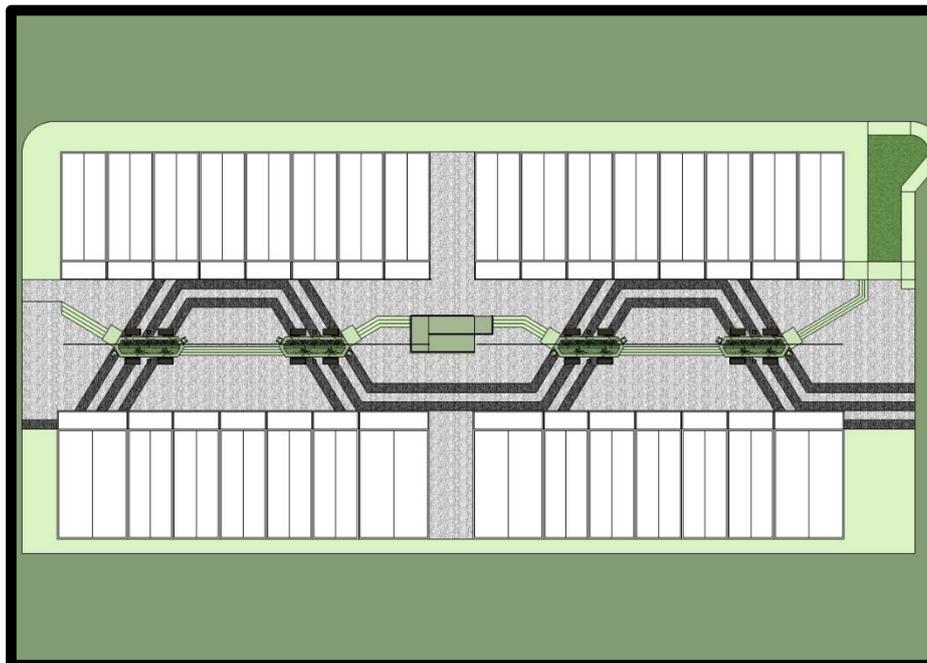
Planta da cobertura proposta para a área pública situada entre os blocos de comércio 7, 9, 13 e 15 do Setor Comercial da Quadra 8 de Sobradinho. Fonte: Arquivos da Dilest.
